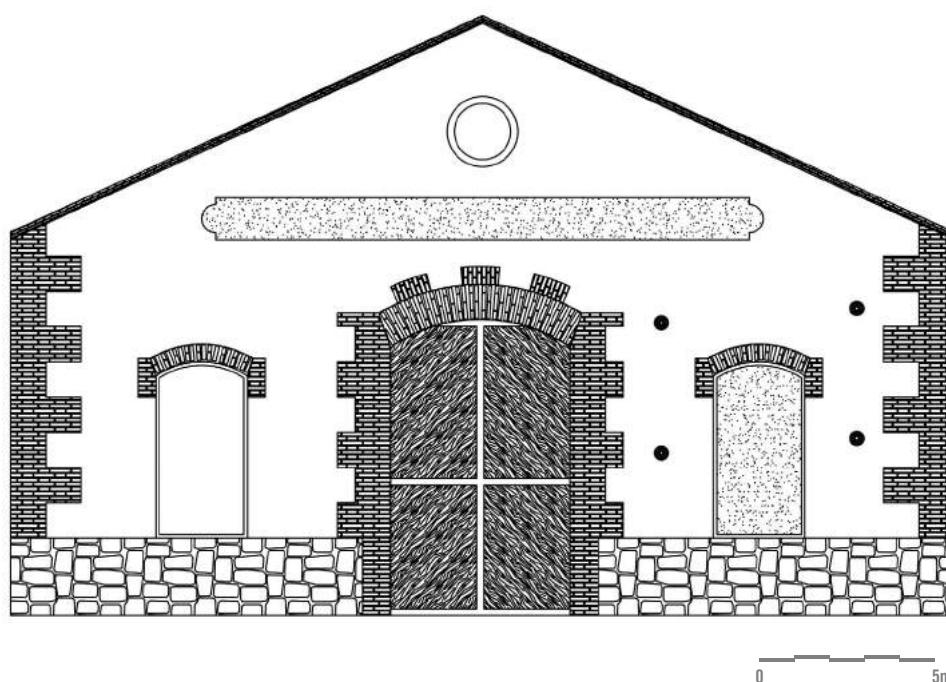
Alzado frontal de la nave de amasado. Desaparecida. Dibujo de Pedro Belmar Merchante.
